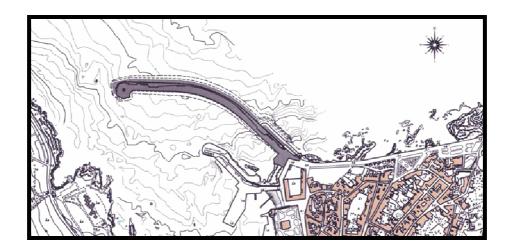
Planimetria con individuazione del progetto di messa in sicurezza del porto
